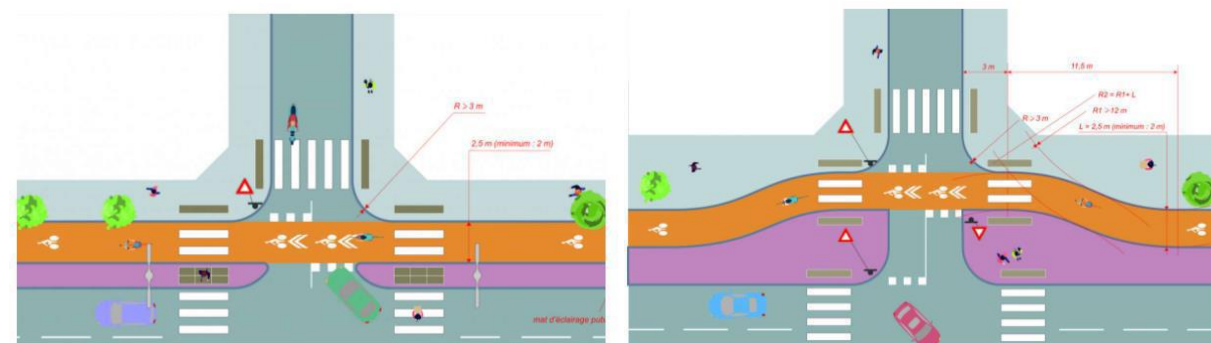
Franchissement à niveau de chaussée (intersection mineure) Figure 24 : Déviation de la piste cyclable au droit de l'intersection (intersection mineure)
